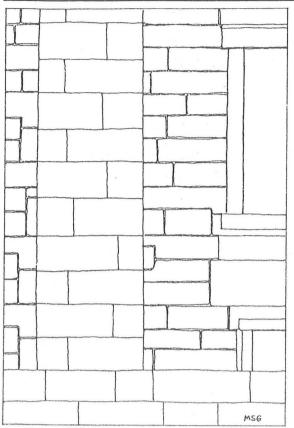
Detalle de la fachada principal del monasterio del Escorial.
